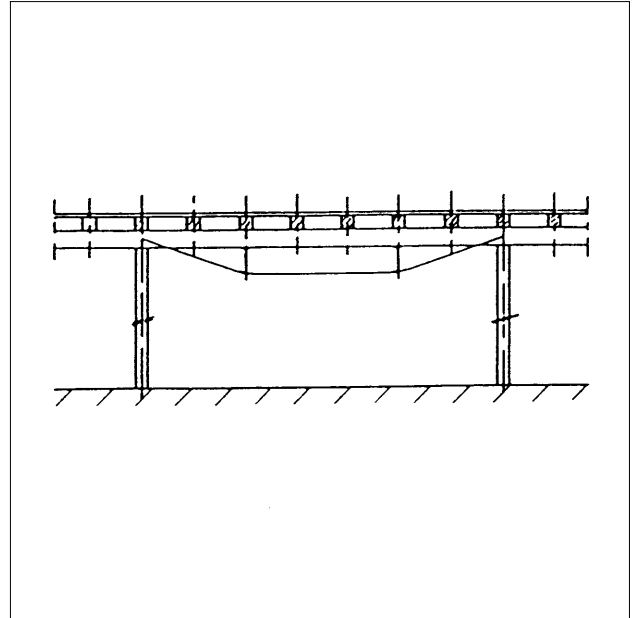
Plancher en bois; renforcement par mise en place d'un tirant en acier.
